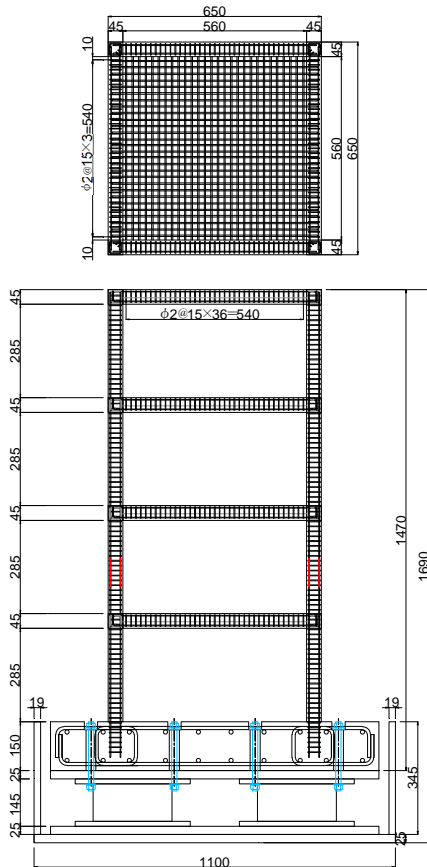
標準試験体 平面・立面配筋図 (単位 mm)
